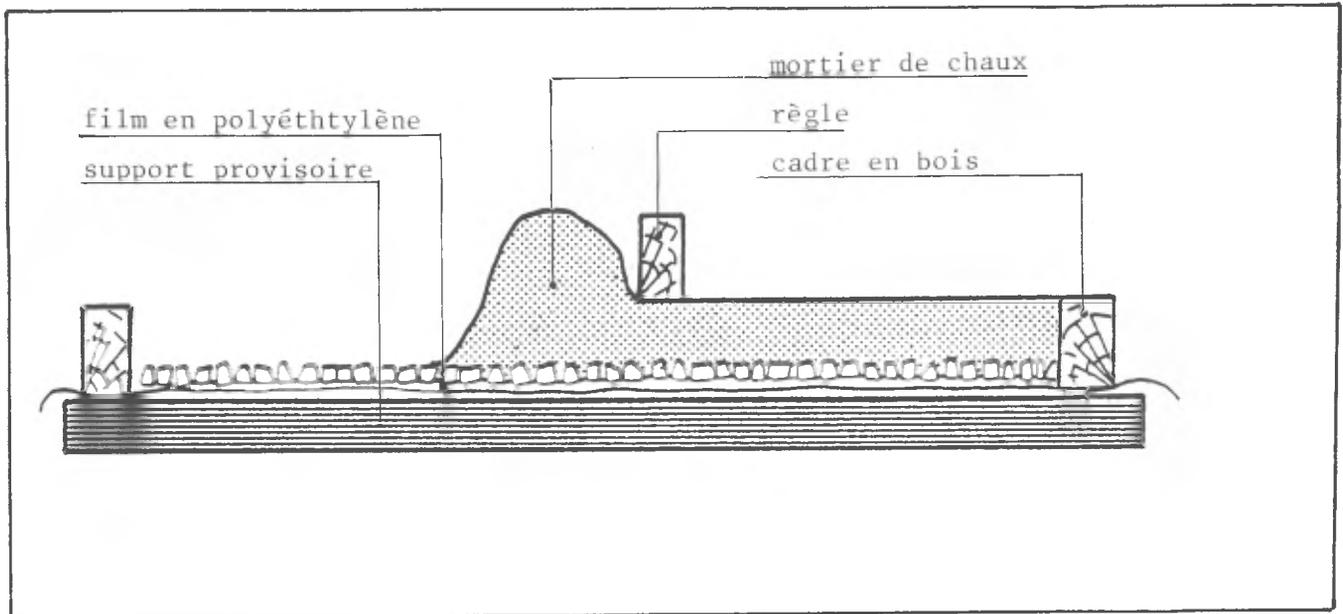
Fabrication d'une dalle en béton de chaux directement sur la face arrière des tesselles.
